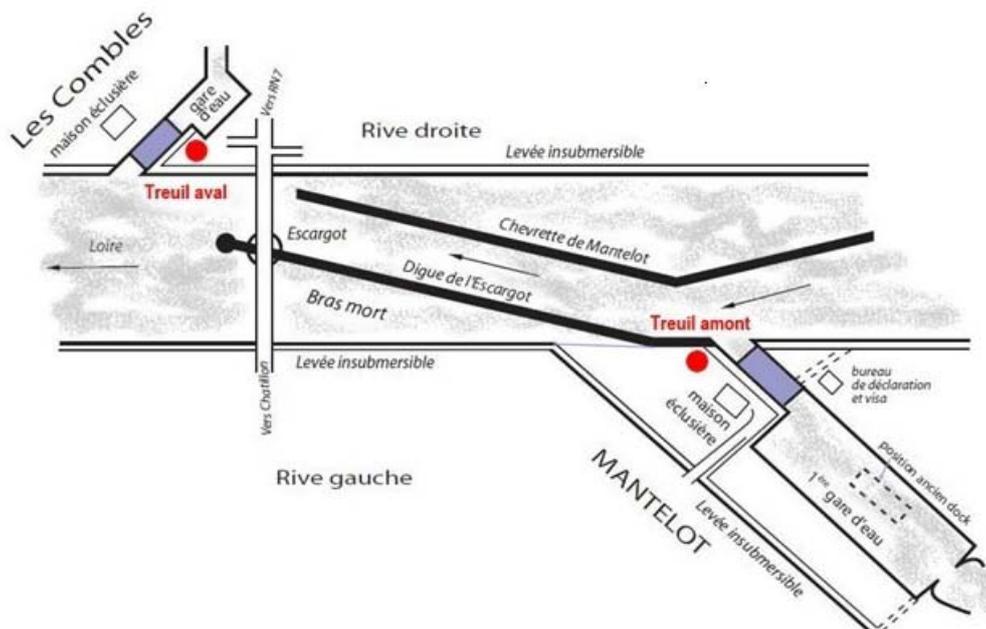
Schéma des ouvrages de navigation historiques (source : dossier du maître d'ouvrage).
